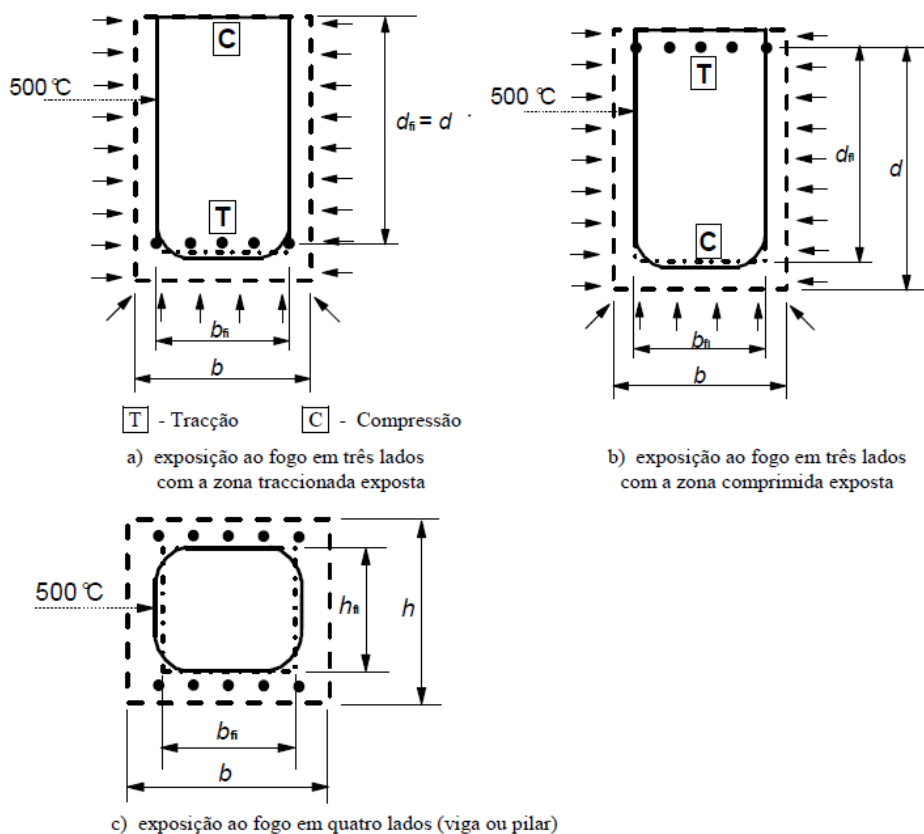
Secção transversal reduzida de uma viga ou um pilar
